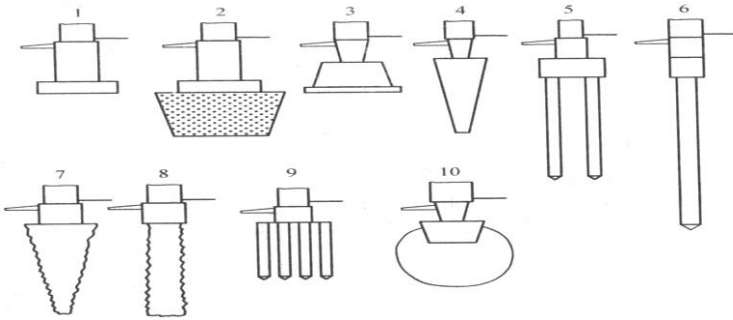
Фундаменти під несучі стіни: 1 - стрічкові; 2 - на штучних основах; 3 - окремі фундаменти з балками; 4 - пірамідальні палі; 5, 6 - призматичні забивні палі; 7 – конусоподібні набивні палі; 8 – циліндричні набивні палі; 9 – мікропалі; 10 – фундамент у витрамбуваному котловані.
